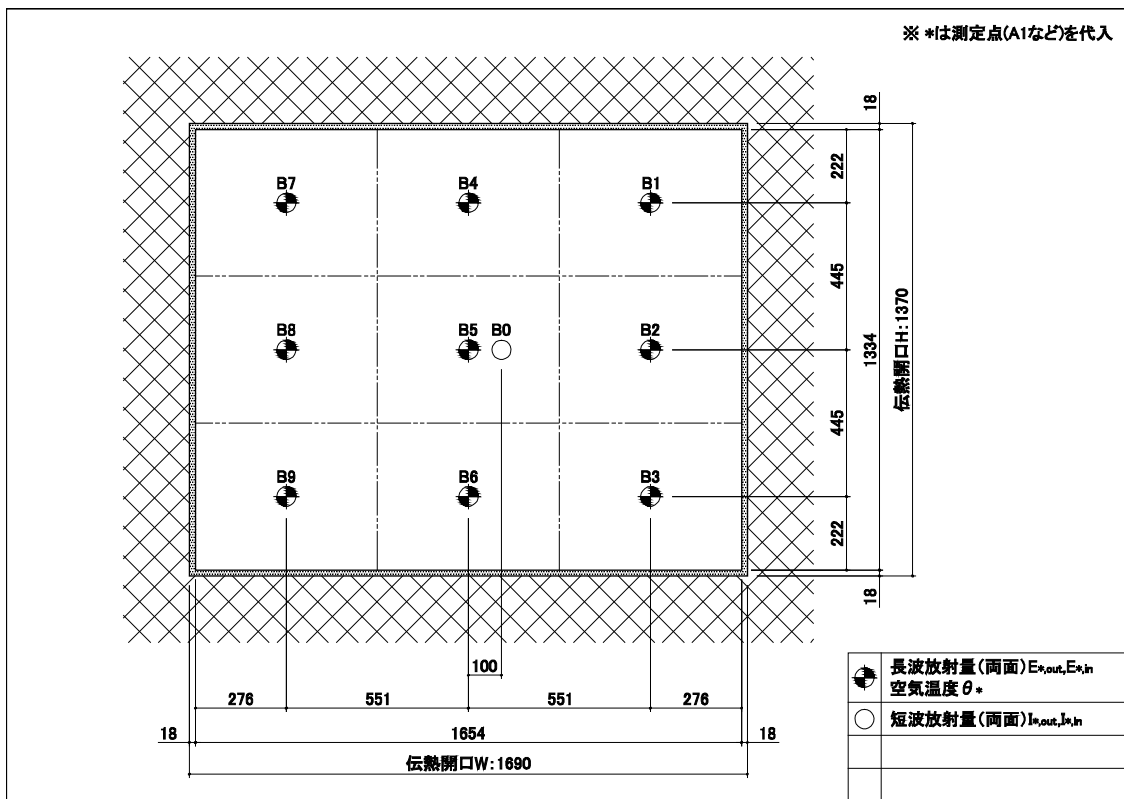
センサー配置図 (中空, Section B, ※内観を示す)
